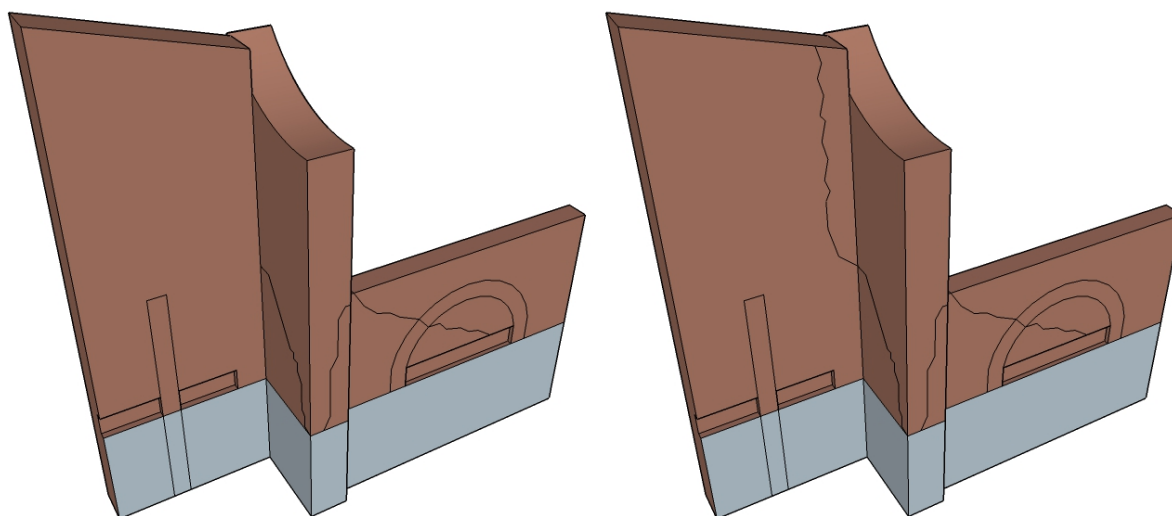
Desplazamiento vertical de la grieta. Fuente propia.
